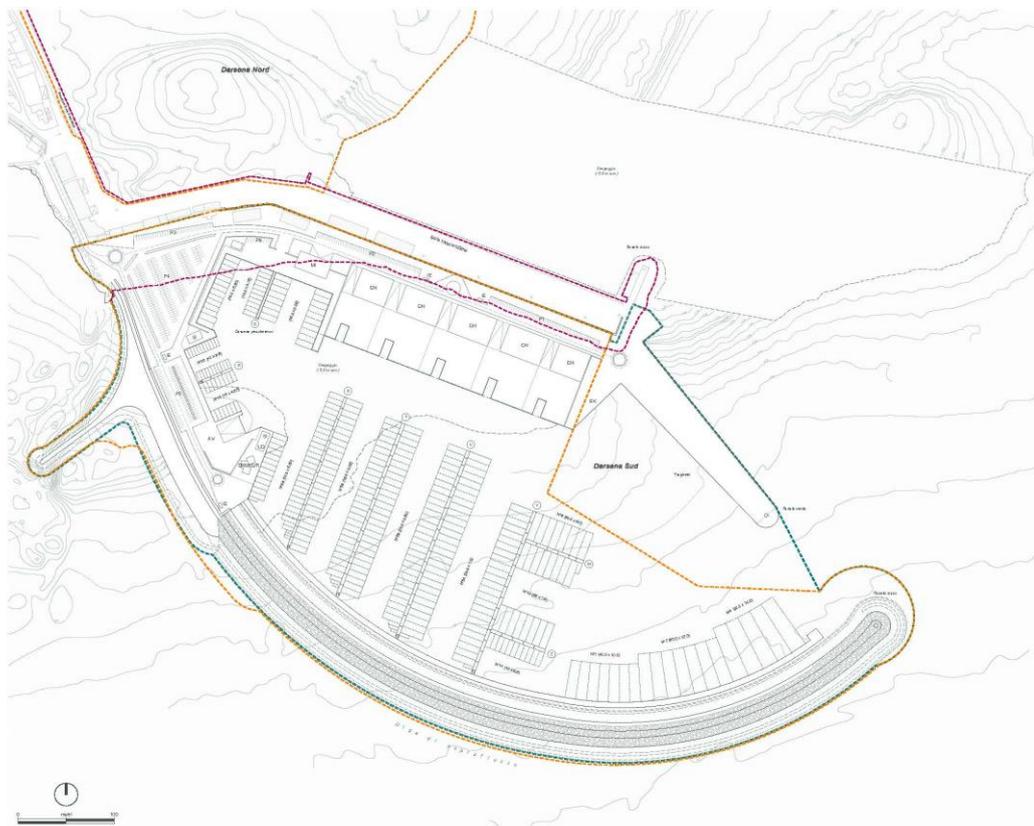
Planimetria di sovrapposizione progetto - stato di fatto
